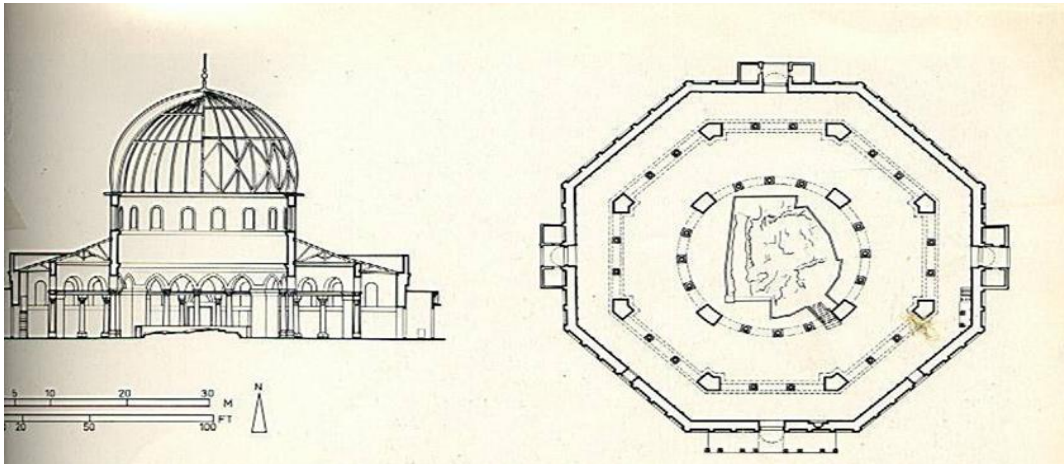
le Dôme du rocher, coupe et plan Source (Stierlin, 1979, p29)
